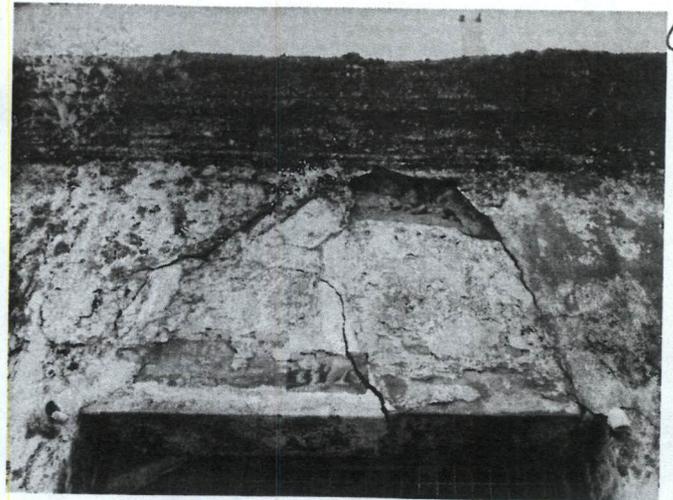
Pormenor de fissuração na padieira da porta no alçado principal
